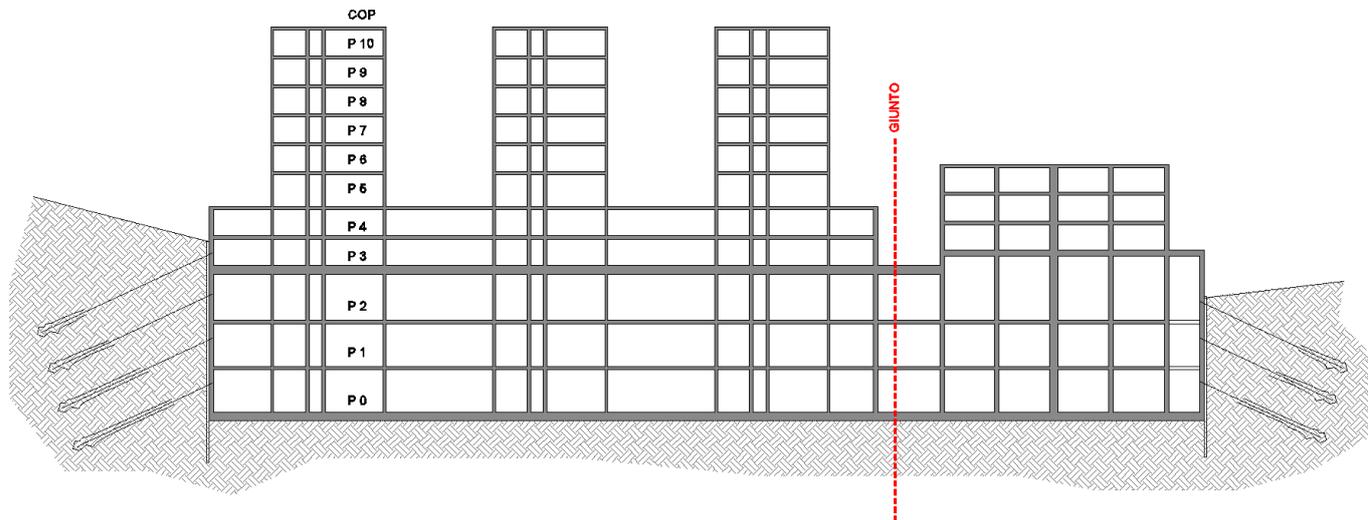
SEZIONE LONGITUDINALE SCHEMATICA
